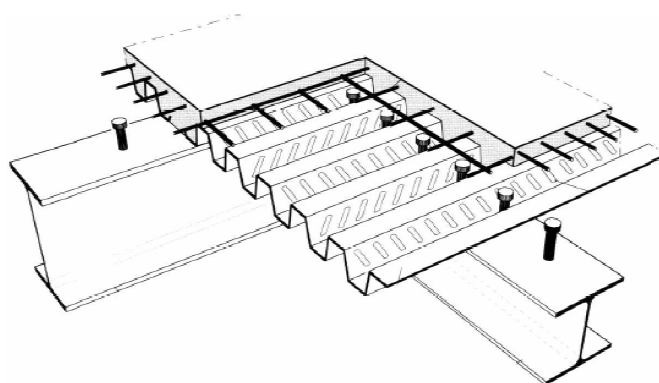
Configuração tipo de uma laje mista Aço-Betão (Simões, 2012).
